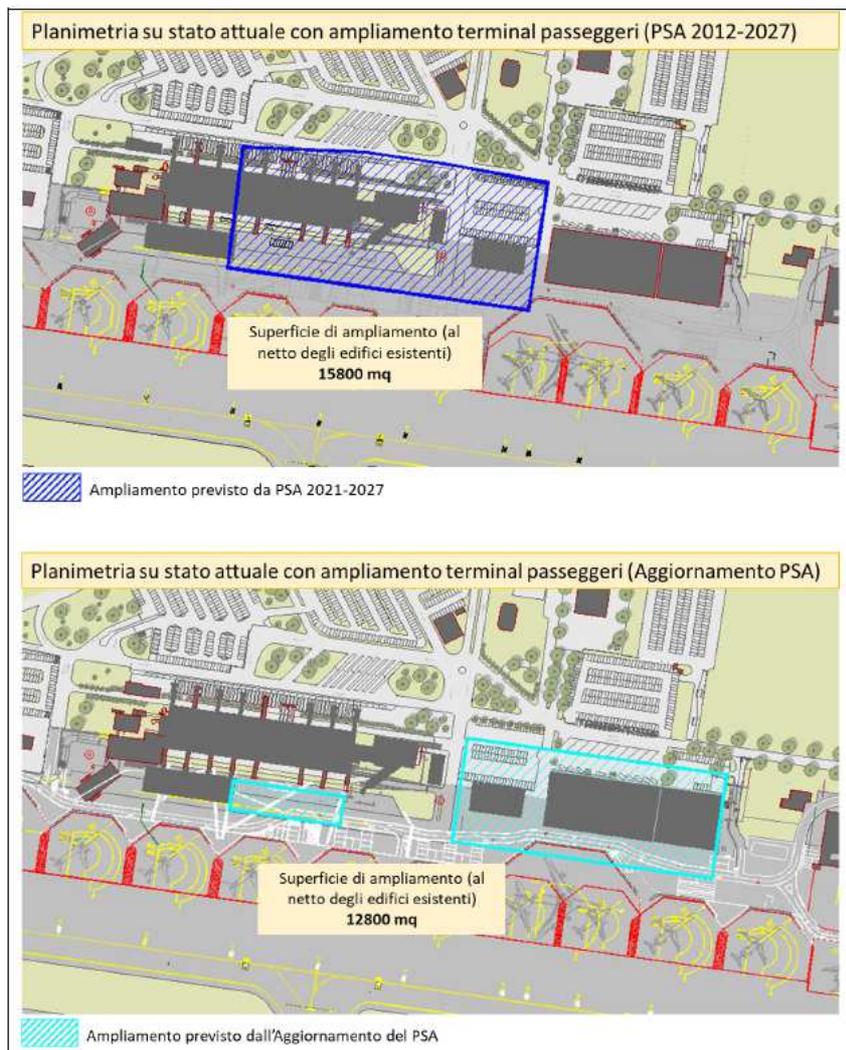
Planimetrie generali PSA 2012-2027 e aggiornamento PSA oggetto della presente istanza
